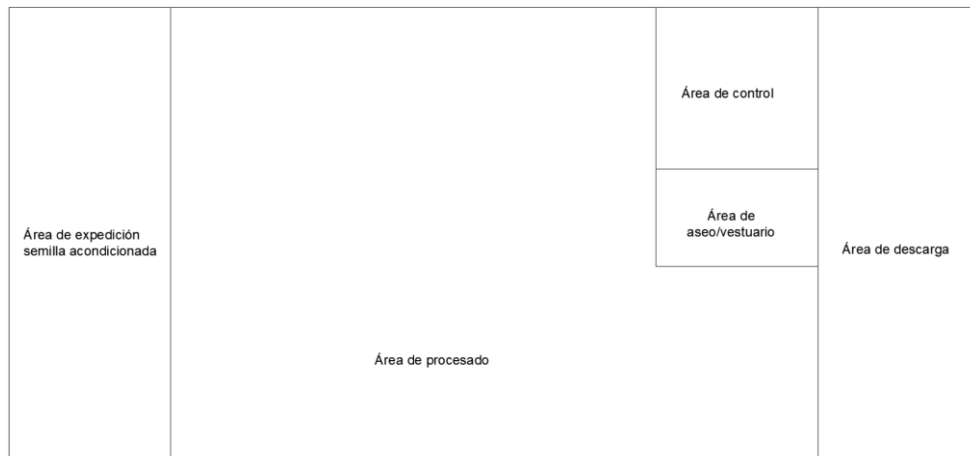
Distribución en planta del área 4. (Sin escala).
